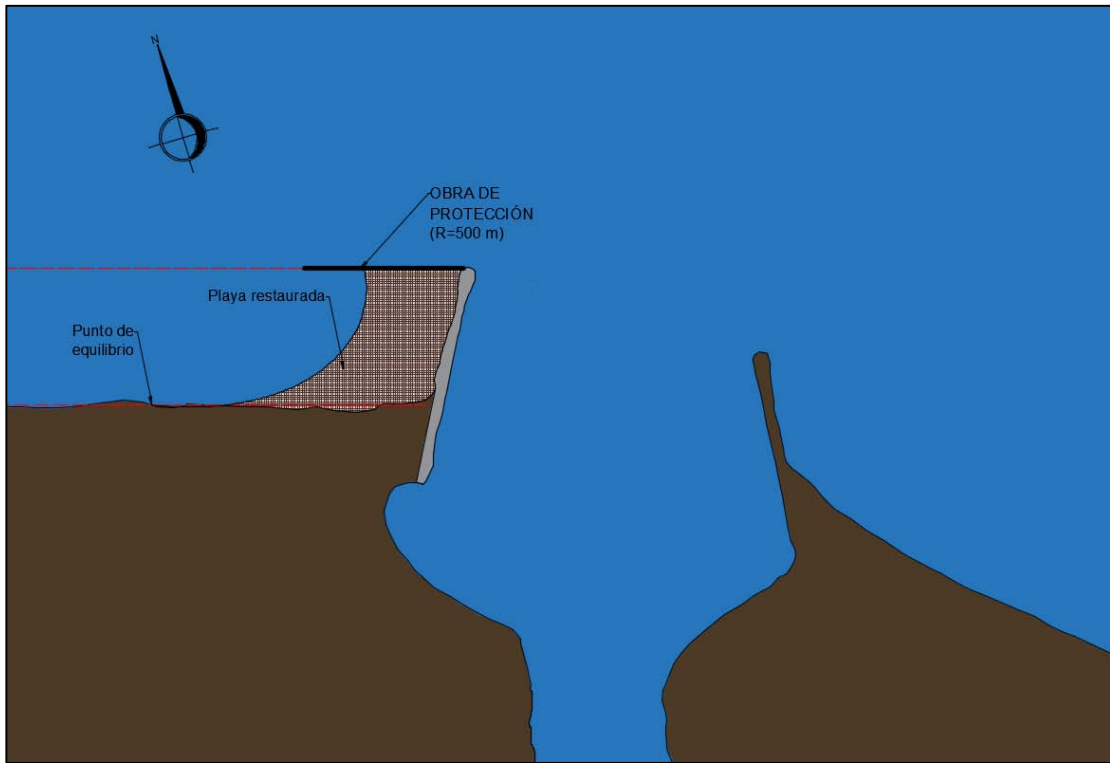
Playa restaurada con una obra de protección de 500 m
